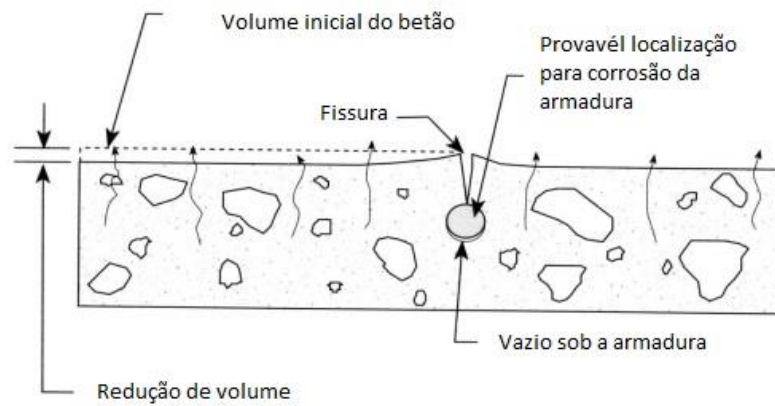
Fissuras por assentamento plástico (civilblog, 2020)
